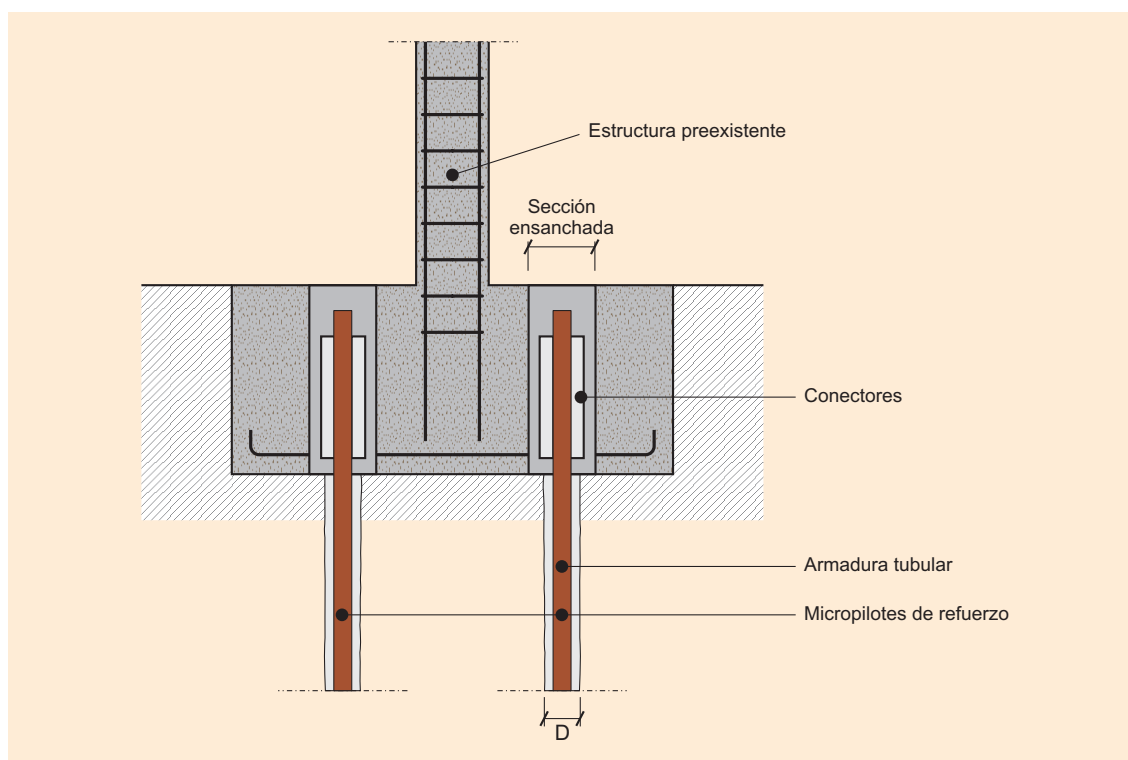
EJEMPLOS DE CONEXIÓN DIRECTA A UNA CIMENTACIÓN PREEXISTENTE DE HORMIGÓN ARMADO
